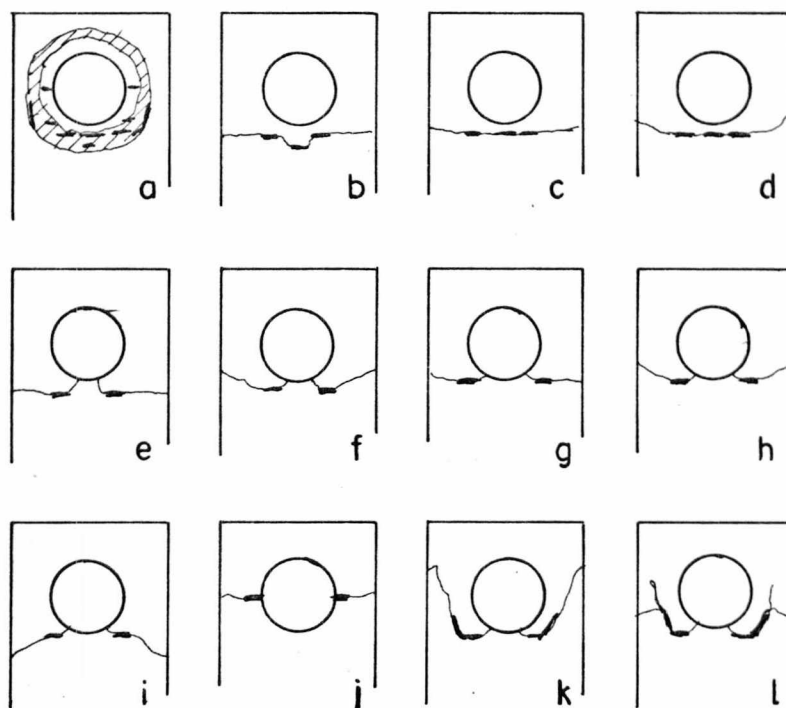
Classificação e origens das fissuras e oxidação.
